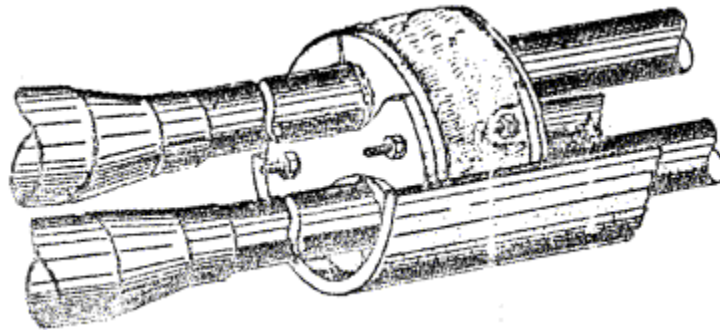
Разрезное герметизирующее устройство на 2 кабеля (ГУЗКр-2), установленное в канале
